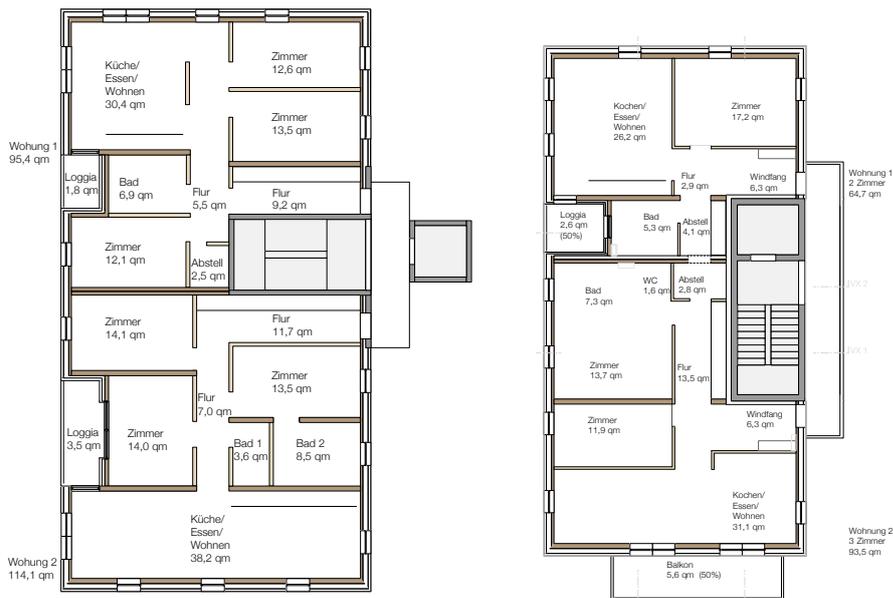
Grundrisskonzepte mit Laubengang-Erschließung
